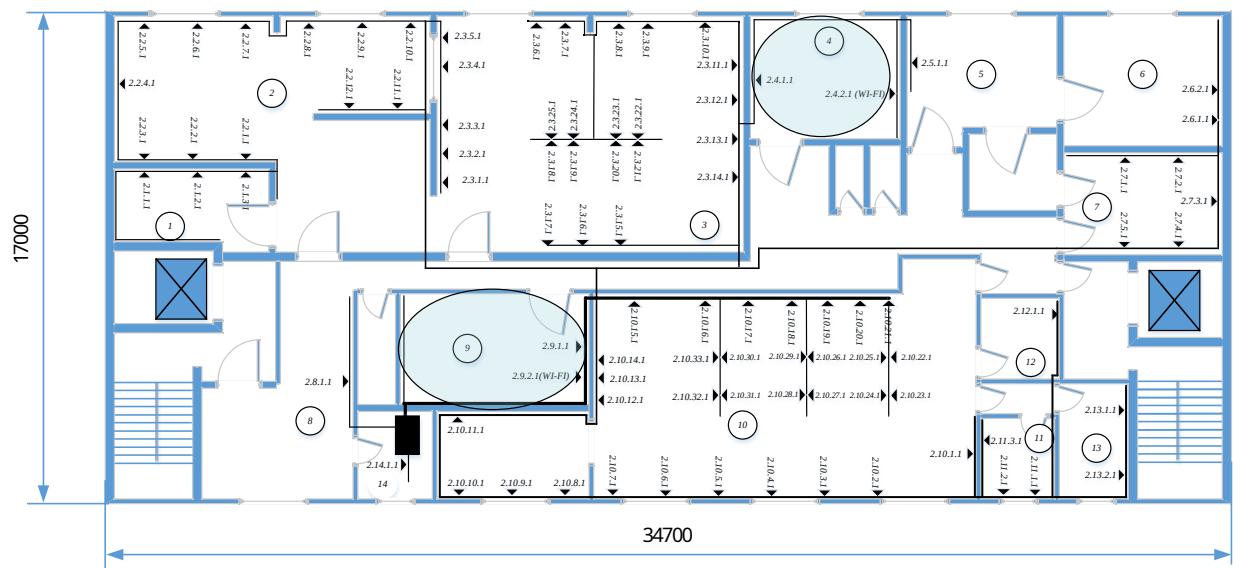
Достаточная зона покрытия для помещений 2-го этажа
